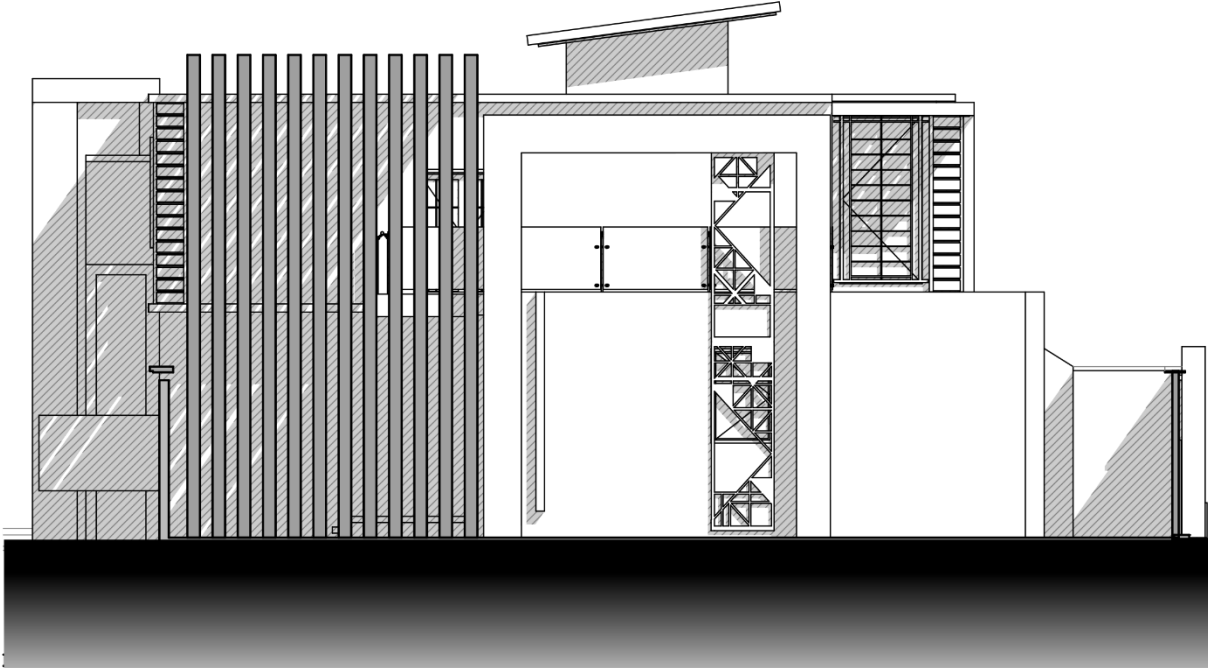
Façade latérale 1 sans clôture ech 1/100.
